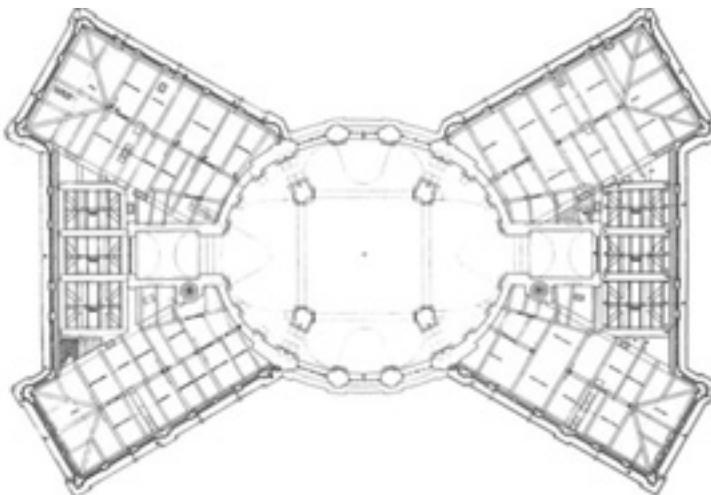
Stupinigi. Fondazione Palazzina Mauriziana di Stupinigi. Salone centrale e appartamenti Reali. Pianta
